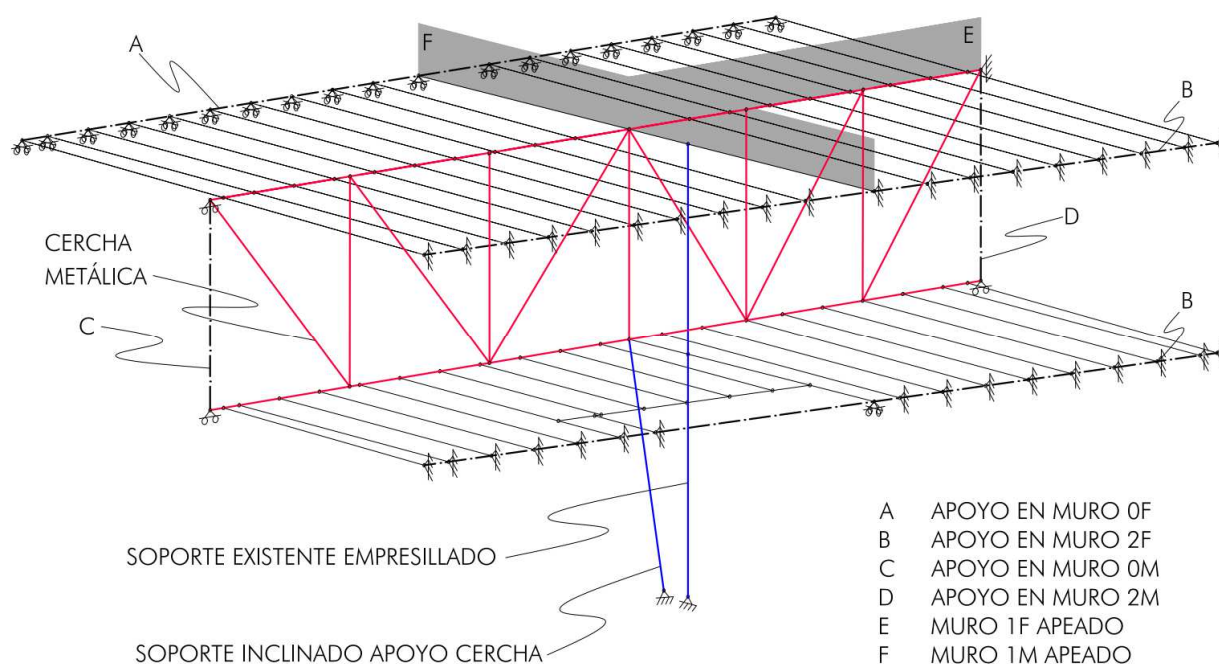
Modelo de la estructura de la entreplanta (+2,60 m) y planta alta (+5,80 m)
